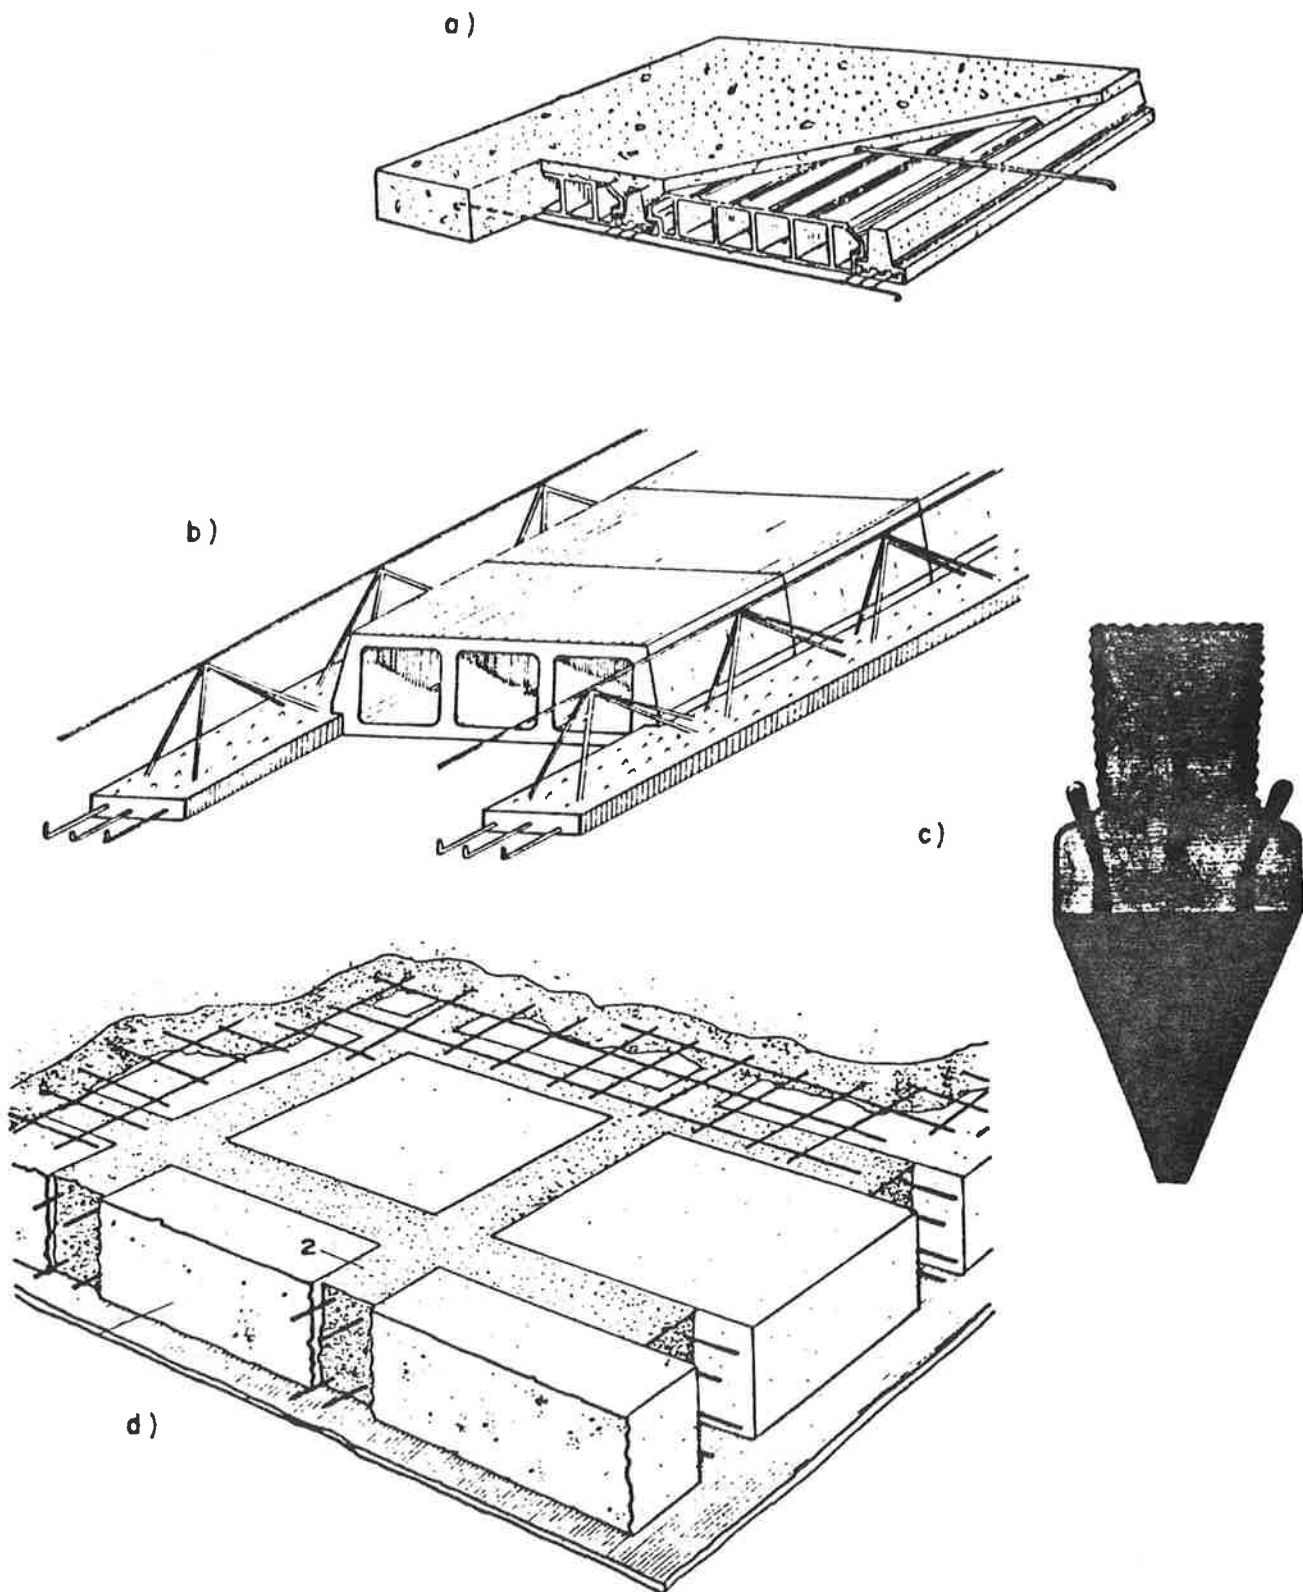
Lajes nervuradas: a) nervuras de concreto armado; b) pré-nervuras de concreto armado; c) nervuras de concreto protendido; d) nervuras moldadas "in loco".
